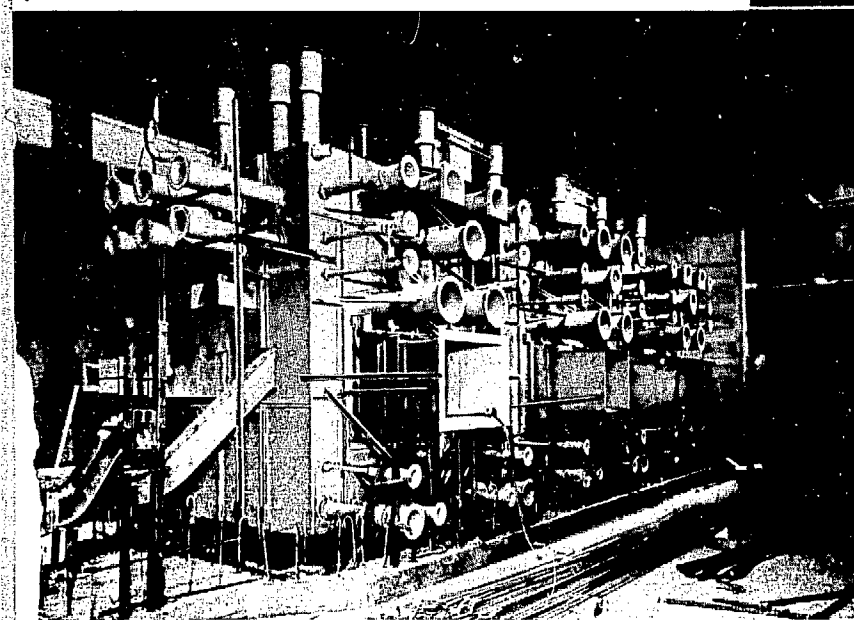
ケーブの前面. 重量コンクリート打設前で, 各種
